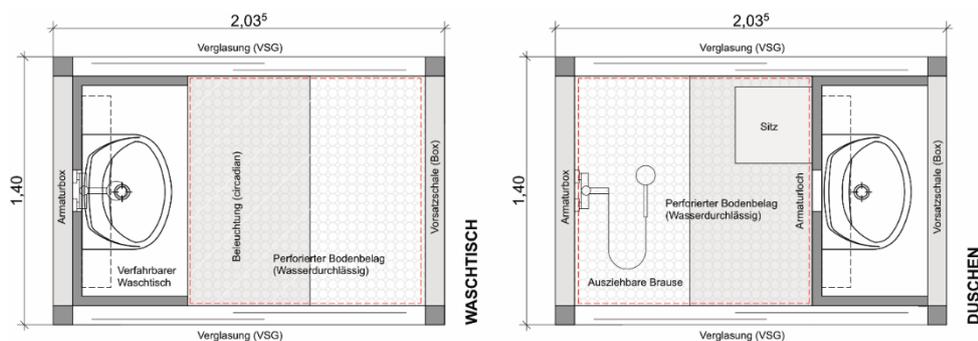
Grundrissdarstellung, Konzeptstatus-02
